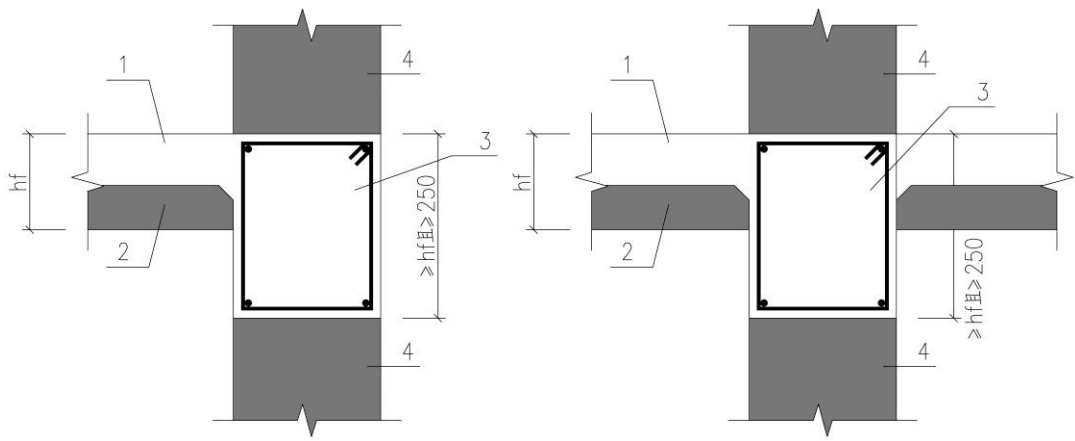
后浇钢筋混凝土圈梁构造示意
